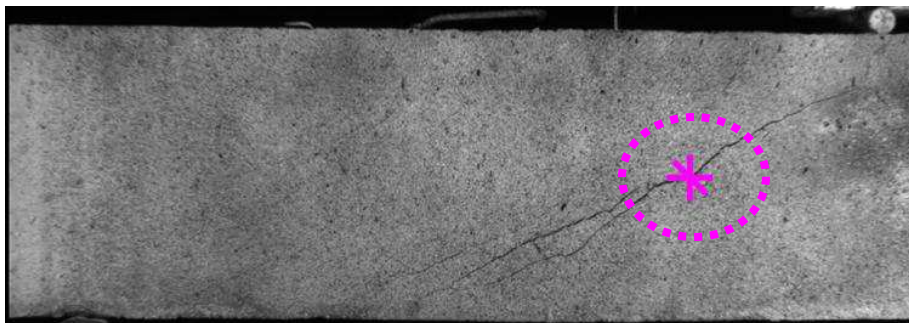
Position de l'extensomètre par corrélation d'images verticale, horizontale et perpendiculaire à la fissure, sur la première poutre « R40 »
